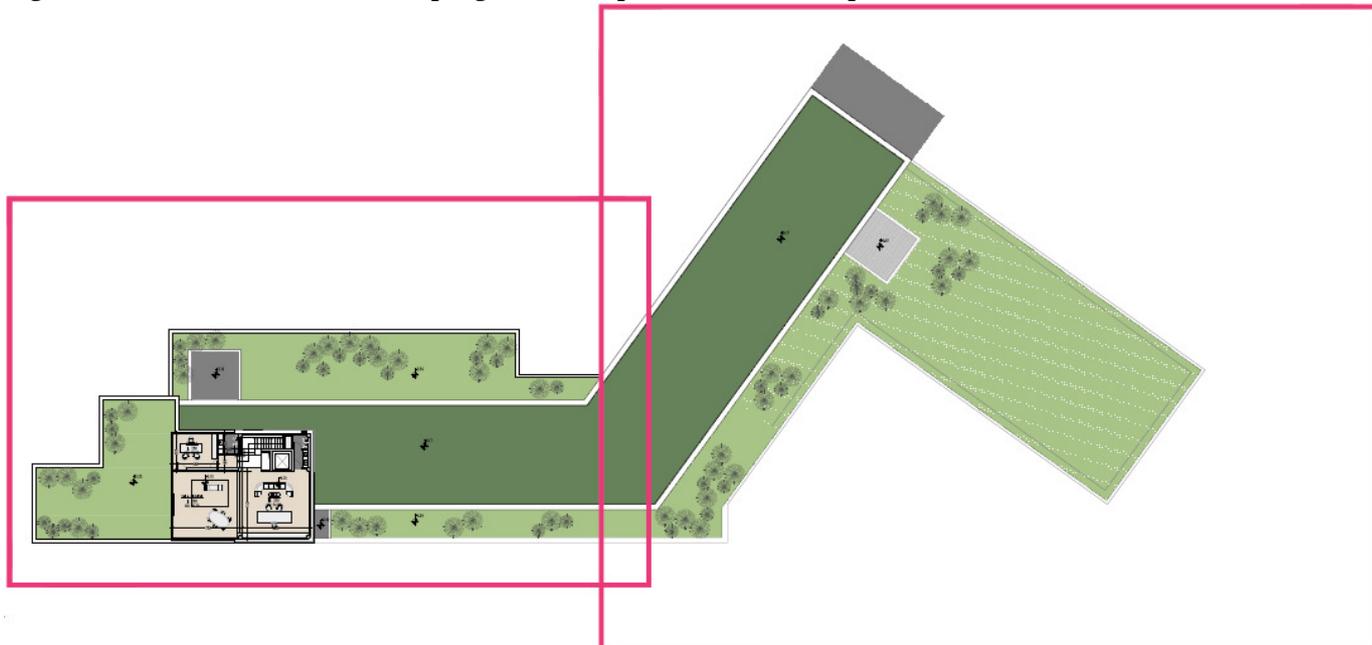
estratto Planimetria di progetto A4.04 piano secondo e coperture
